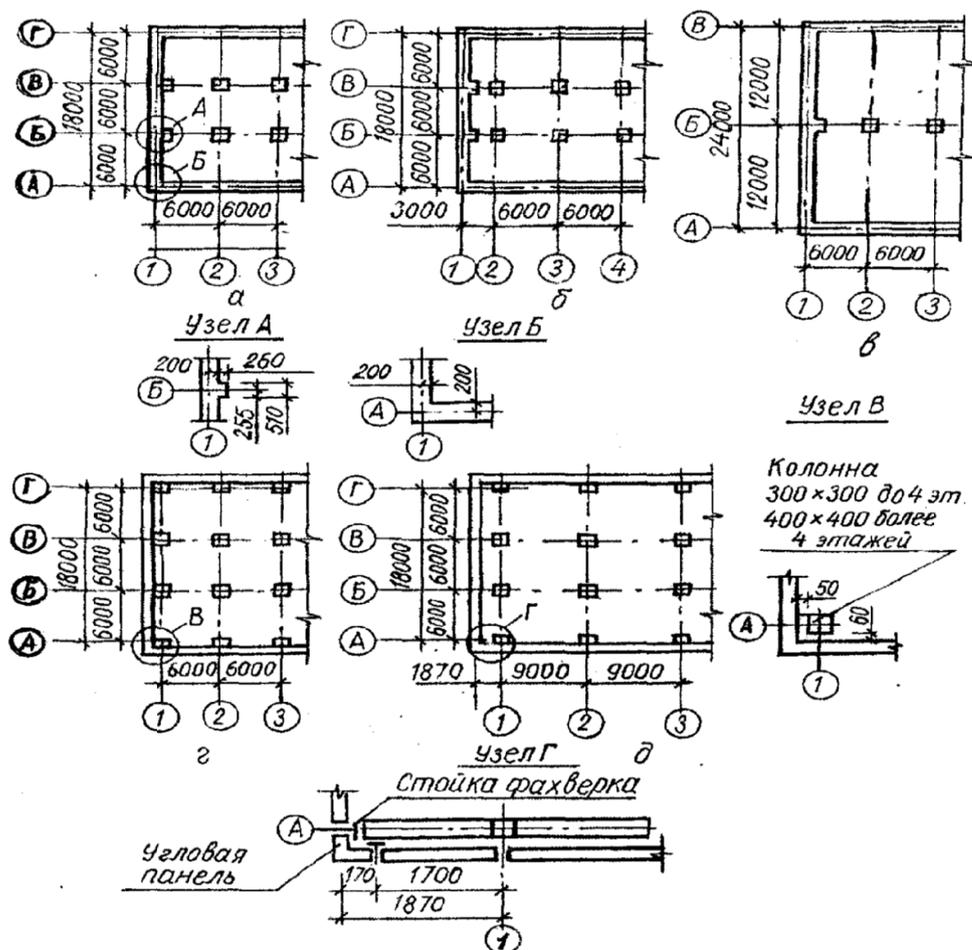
Конструктивные схемы одноэтажных зданий - а, б, в (неполный каркас - кирпичные стены и столбы) и многоэтажных - г, д (каркасные схемы – сборные железобетонные колонны и стеновые панели)
